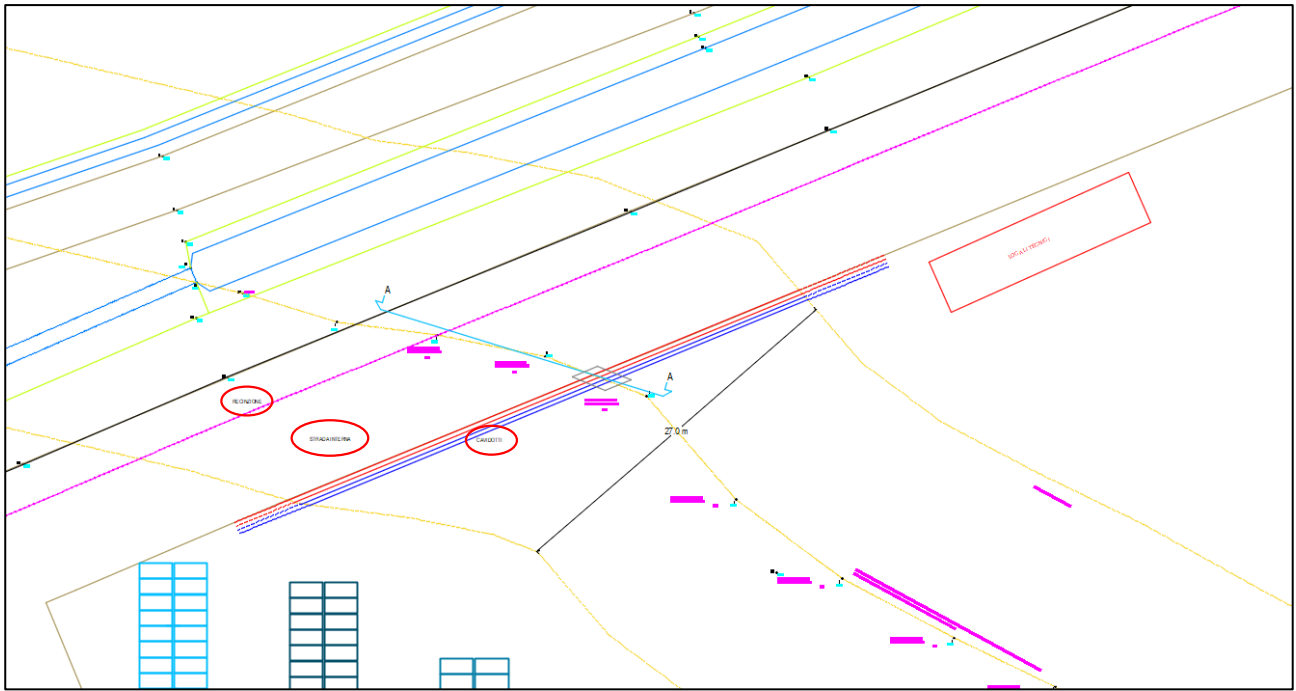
Dettaglio layout con evidenziato fascia di rispetto metanodotto
